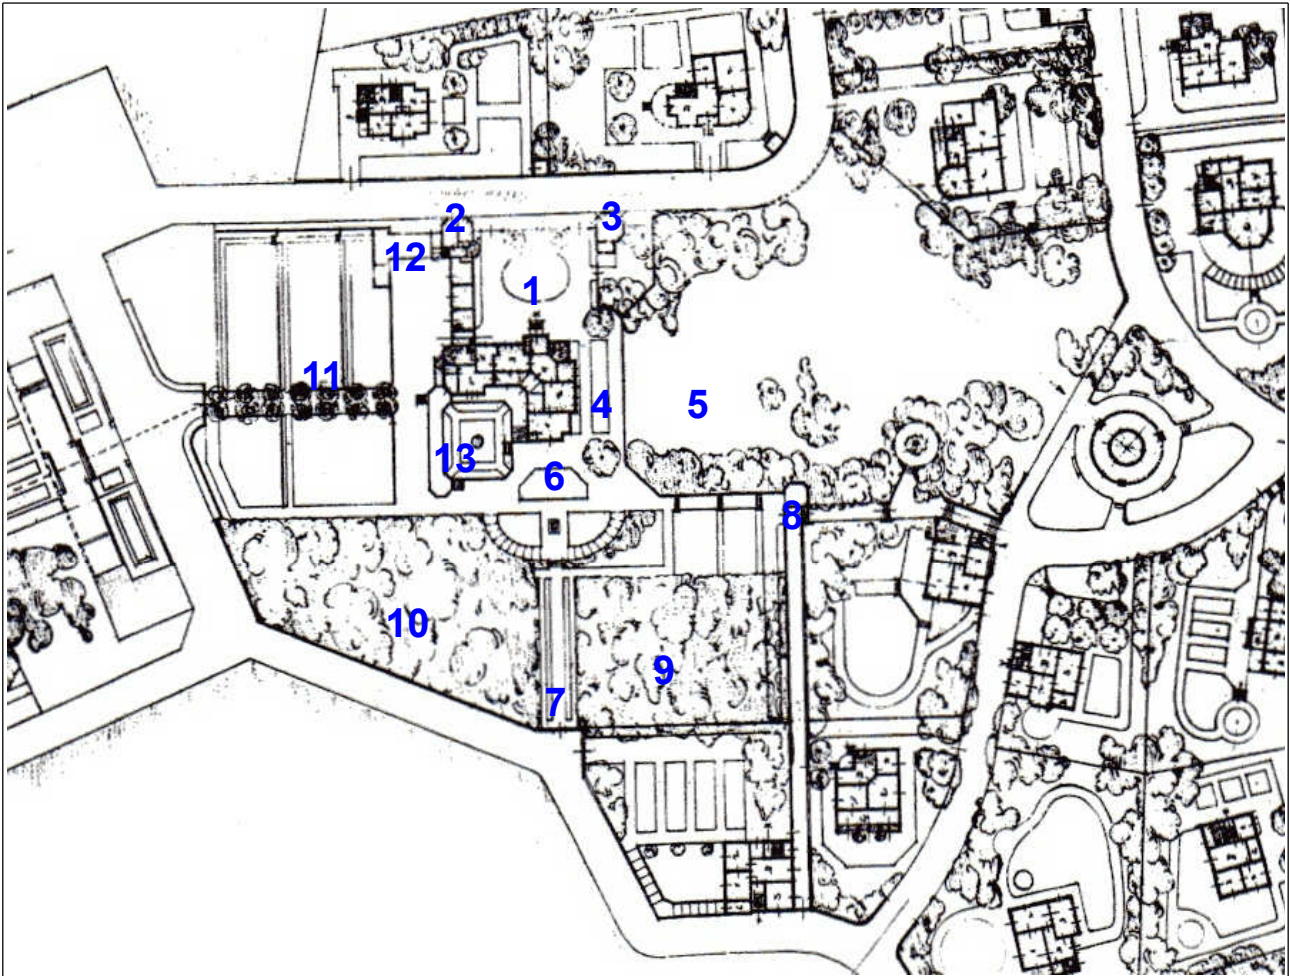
Ausschnitt Bebauungsplan van de Velde 1907
